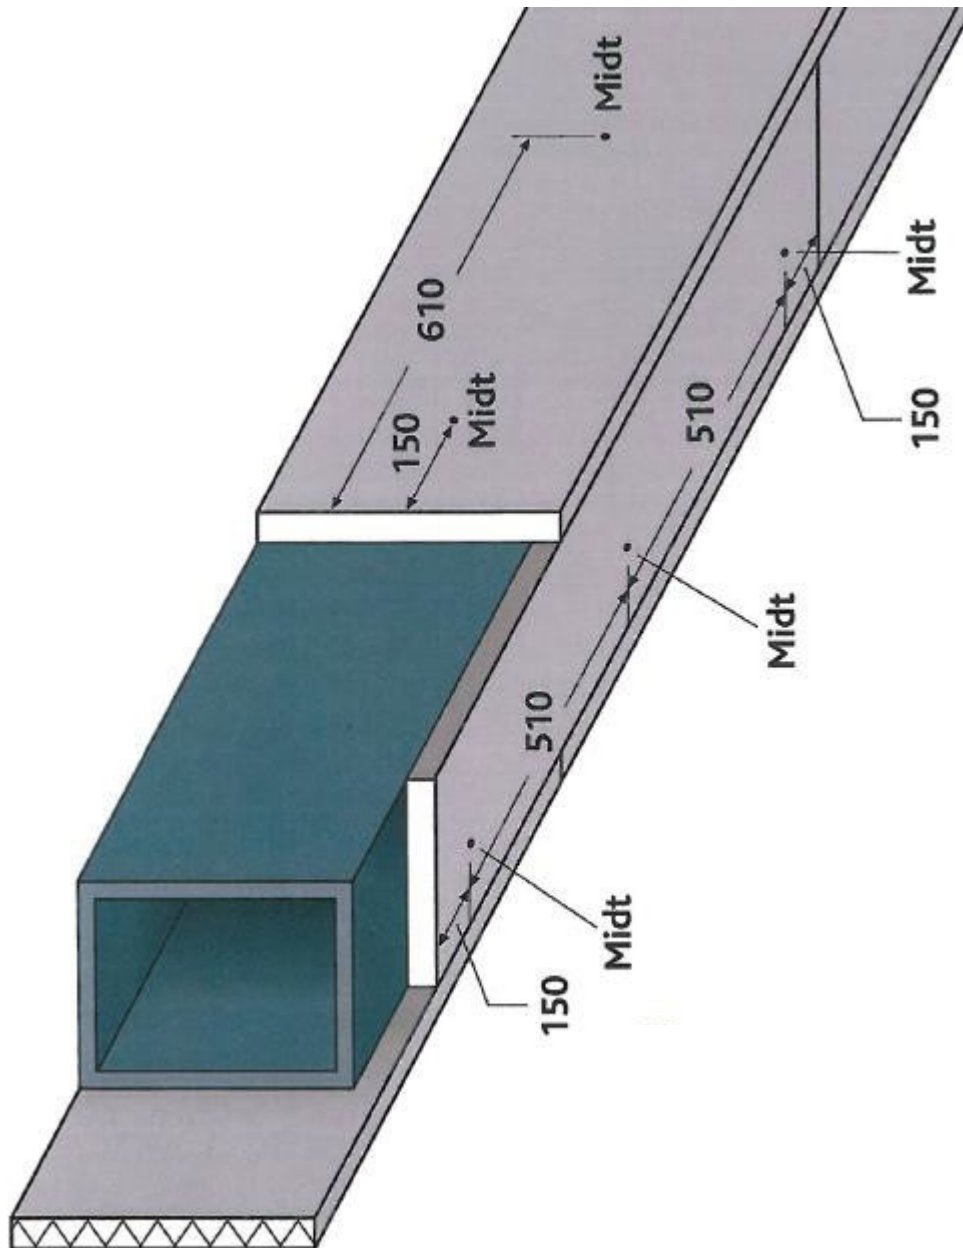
Posición de los clavos de fijación en acero perfilado cerrado: protección a tres lados
